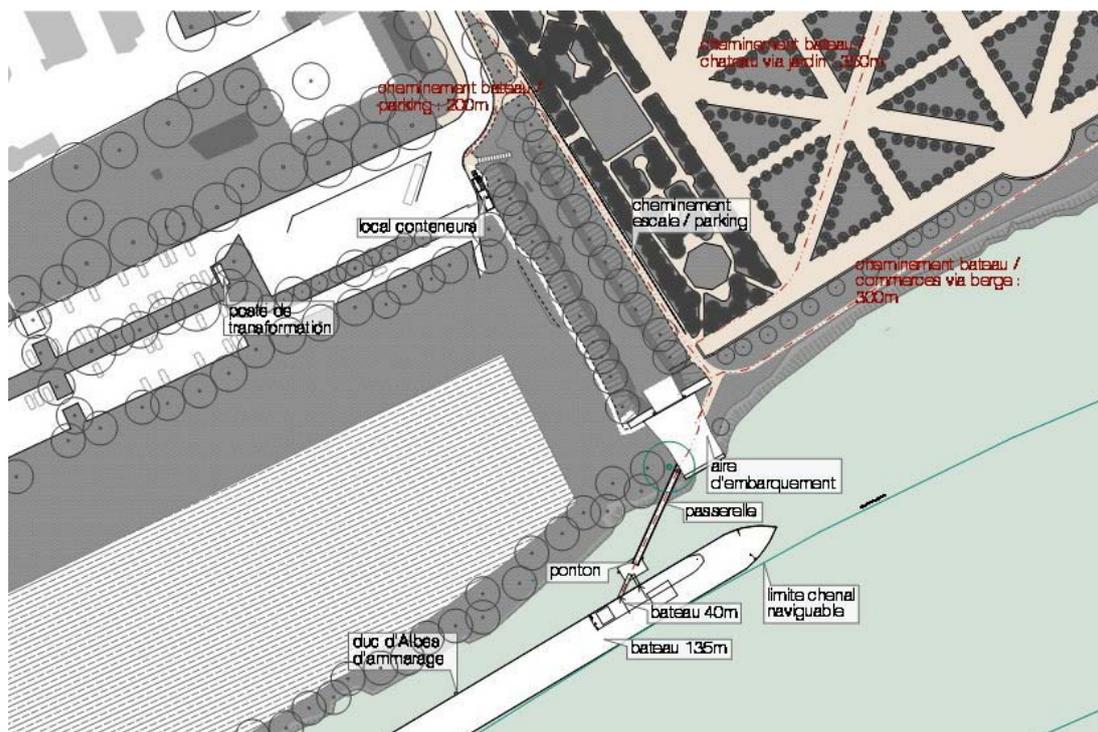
plan d'aménagement de l'escale à passagers. Source : étude d'impact (+ rajout du belvédère)
